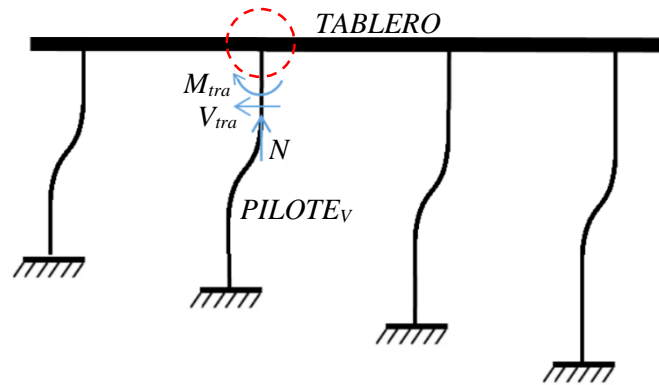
Esfuerzos transferidos a la conexión por los elementos conectores.
